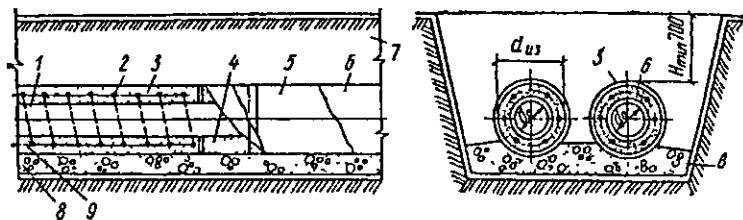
Прокладка трубопроводов в изоляции из монолитного армопобетона
